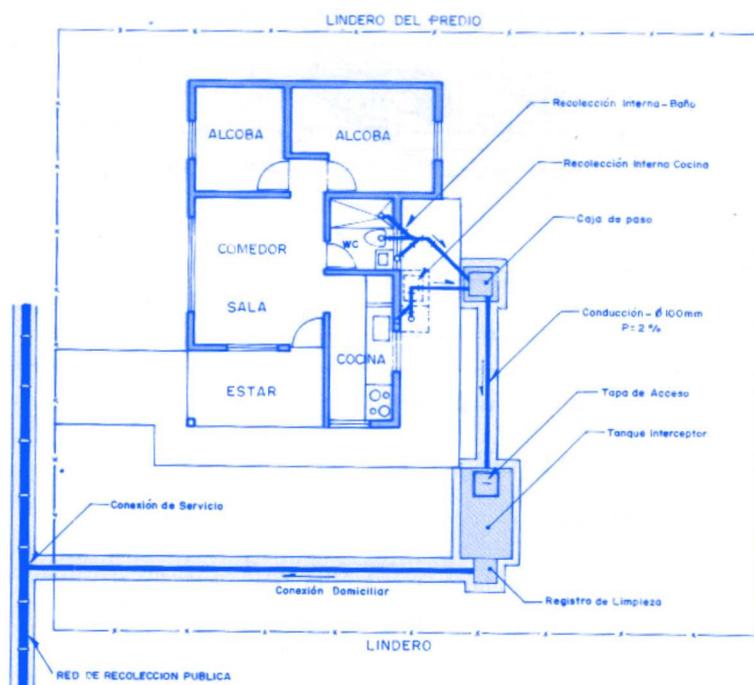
Esquema del Alcantarillado de Flujo Decantado
